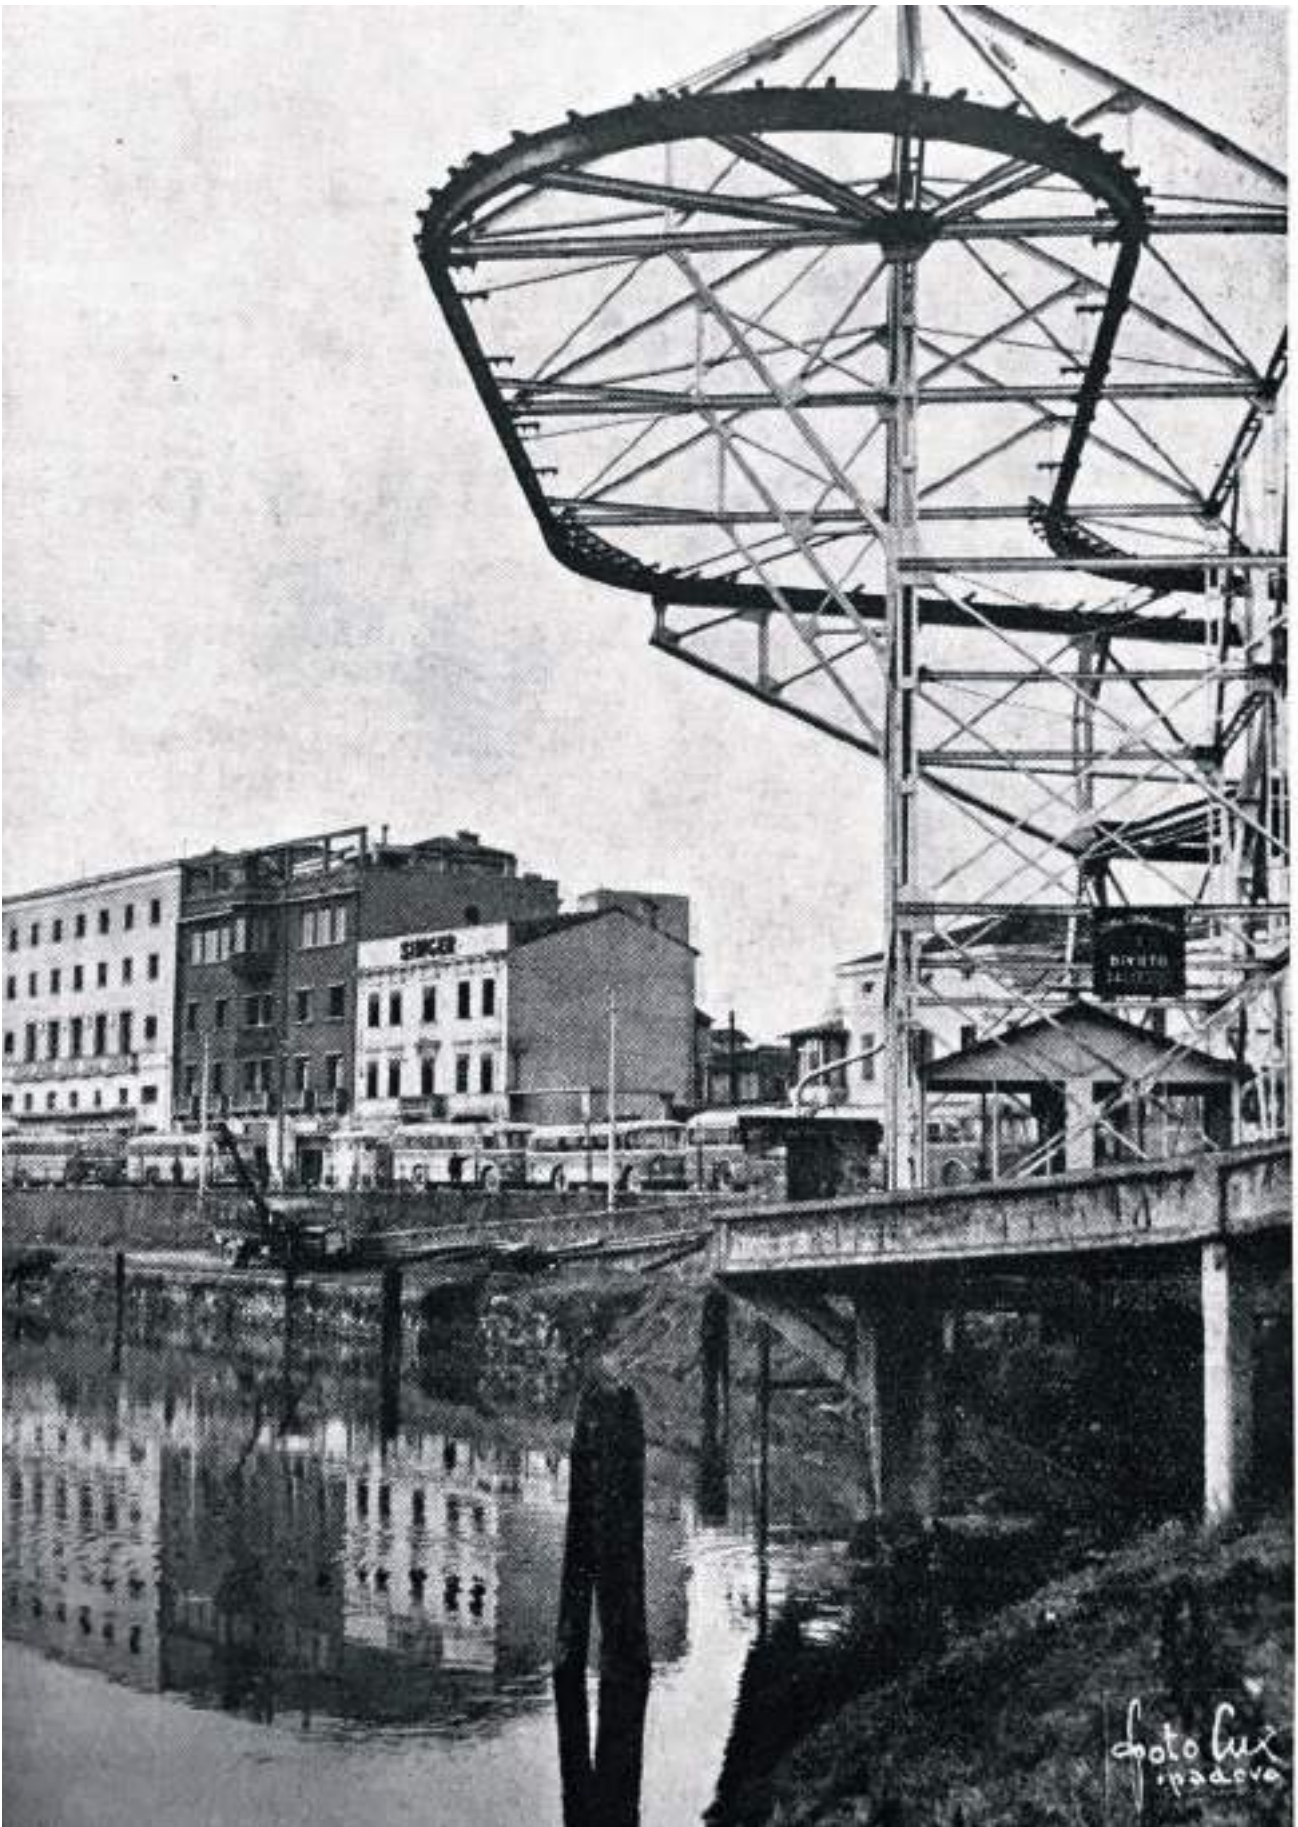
La gru di sollevamento del carbone non più in attività, nel fondo la gru a braccio del nuovo porto.
